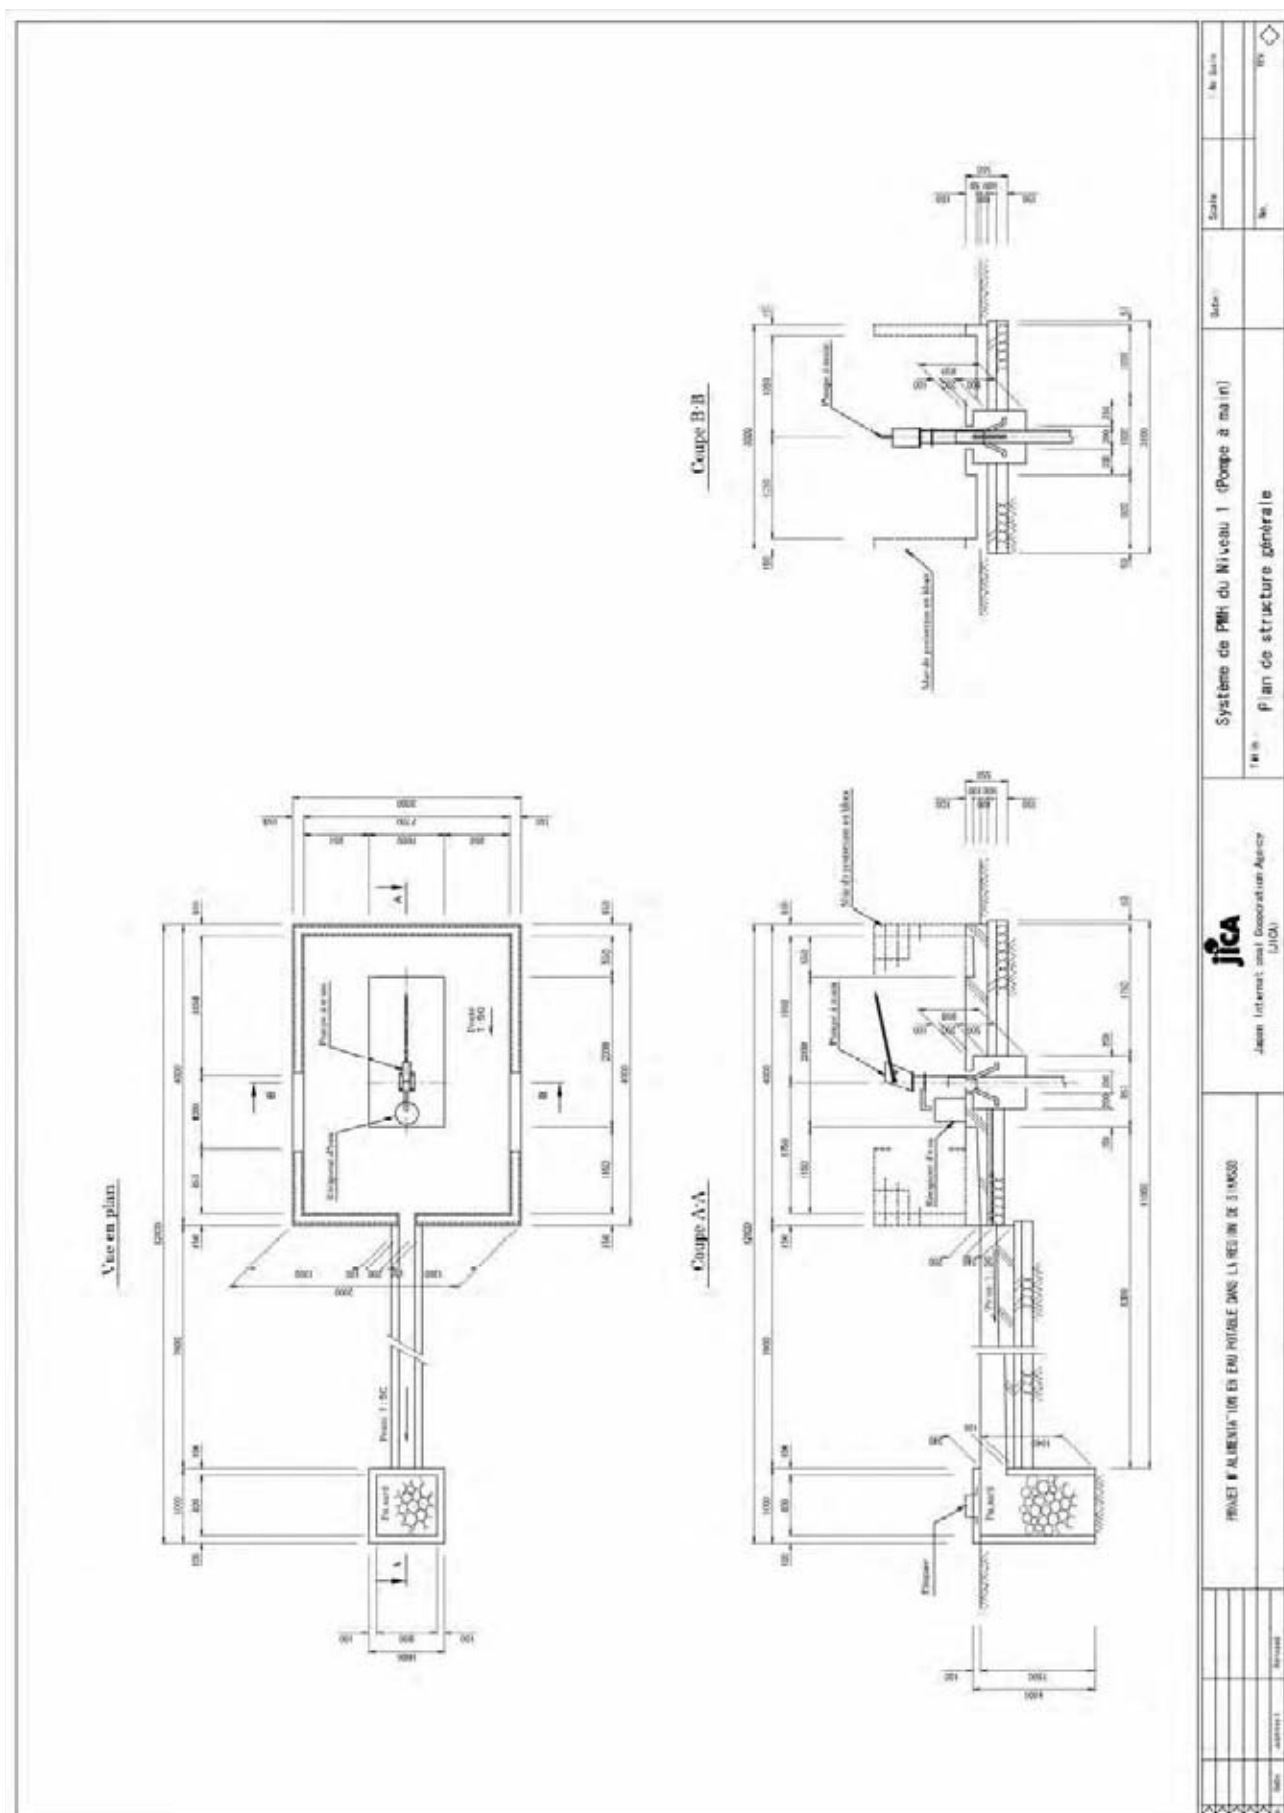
Système de PMH du Niveau 1 (Plan d'installation de la pompe à main)
